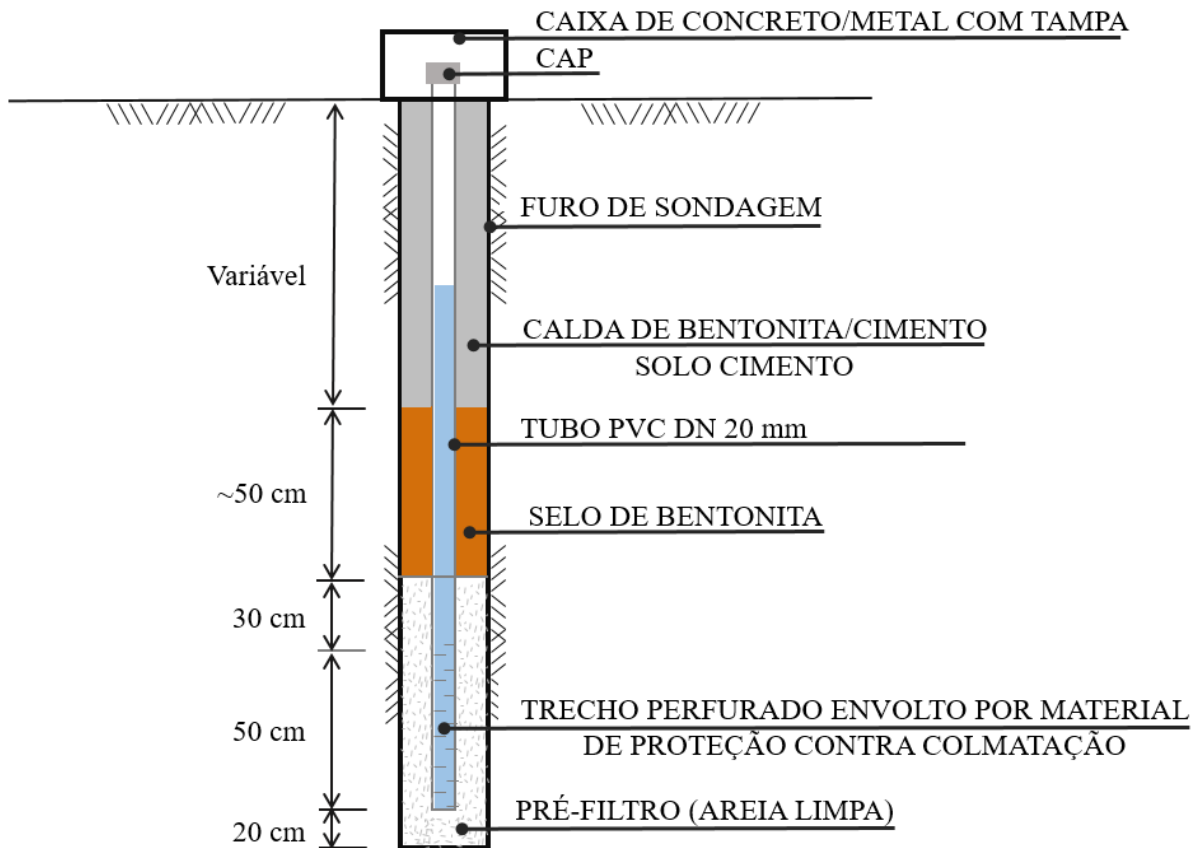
Perfil genérico de instalação de um piezômetro de tubo aberto.
